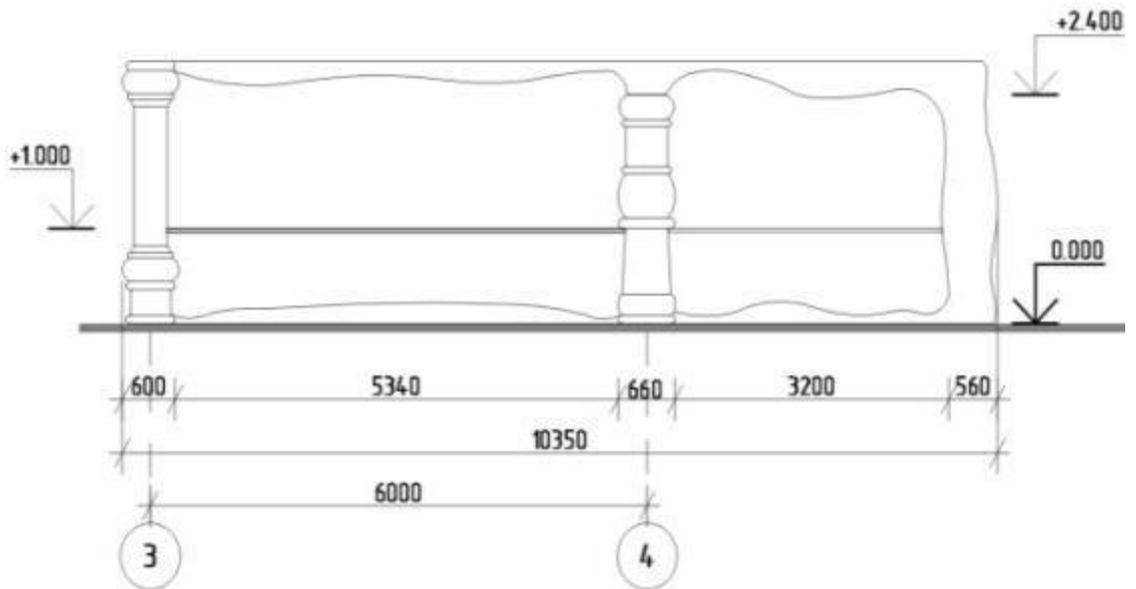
Гардеробная стойка. Фронтальный вид
